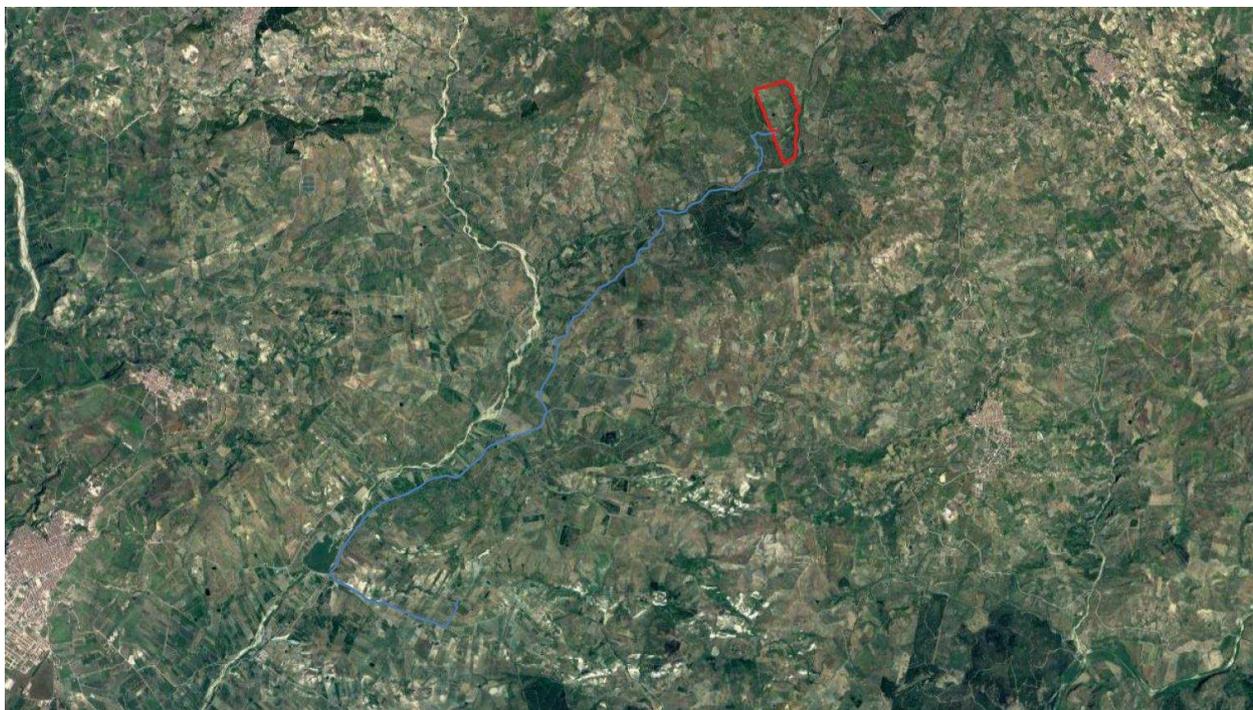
ORTOFOTO CON IMPIANTO E CAVIDOTTO
